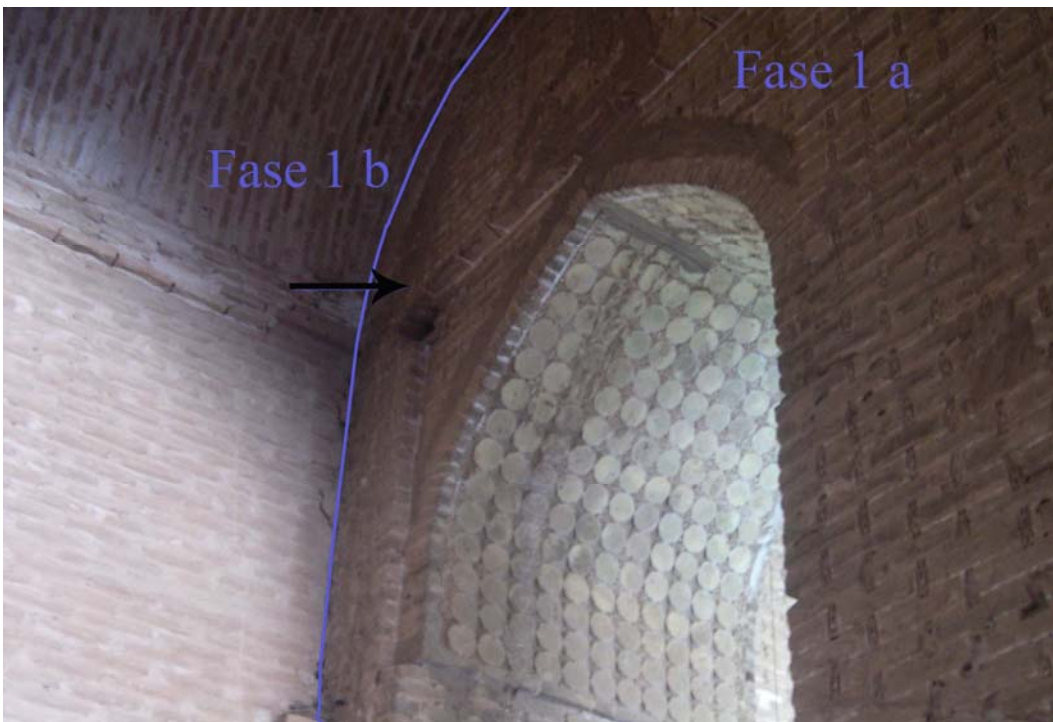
Masjed-e Jāme' di Zavare: *gonbadkhāne*, prospetto E, evidenze volta dello shabestān S-E e del muro *qebli* (foto dell'autore. Settembre 2008)
